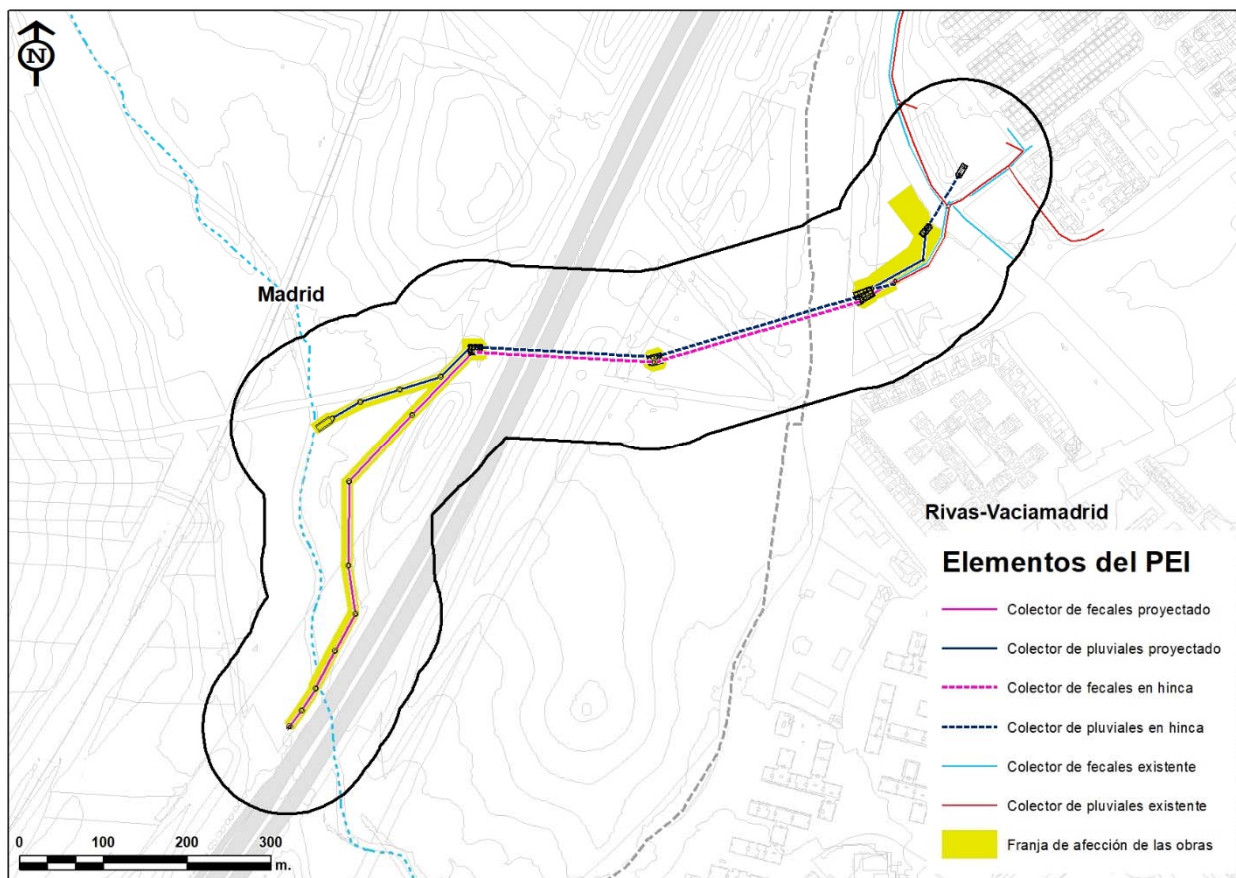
Ámbito Espacial del Plan Especial de Infraestructuras. Fuente. Elaboración propia
